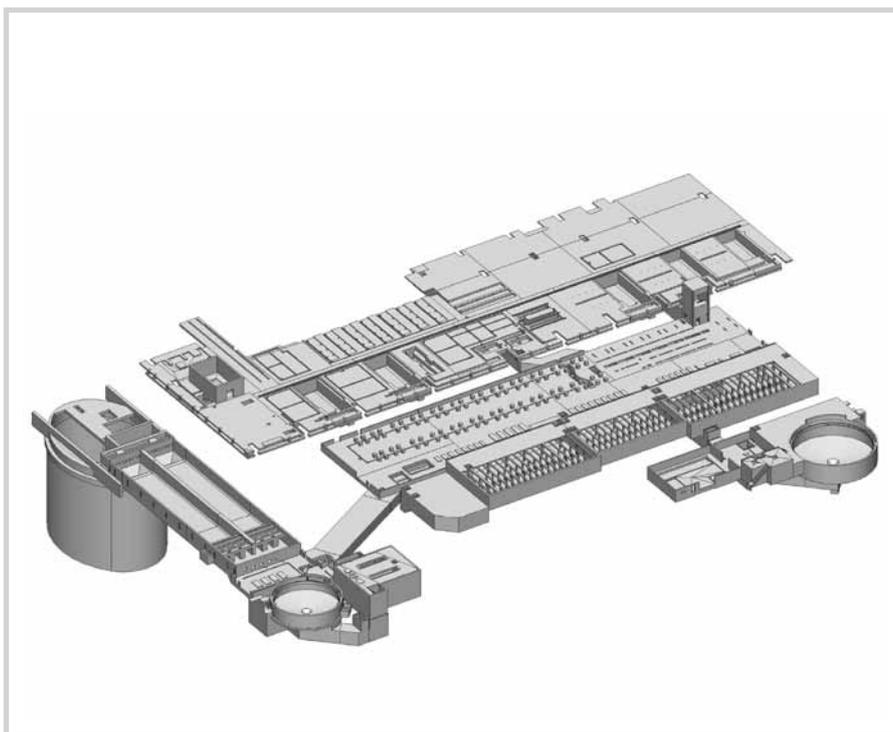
Warmwalzwerk Allegheny USA – Übersicht Betonkonstruktion]
